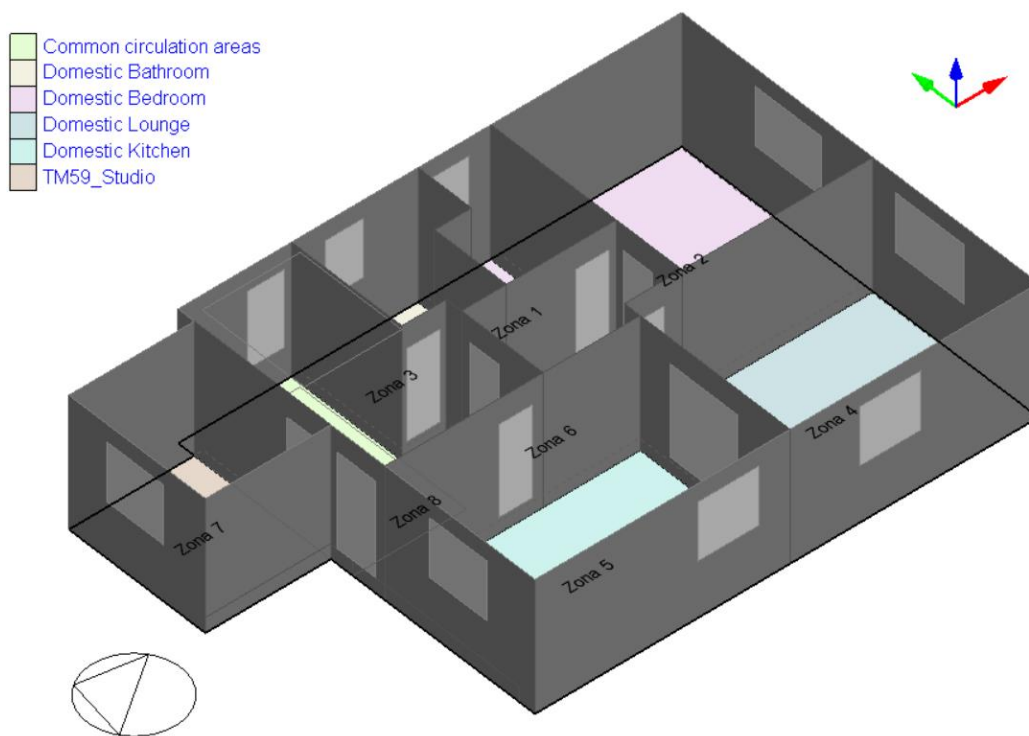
Modelado de la planta baja. (Fuente: DesignBuilder)
